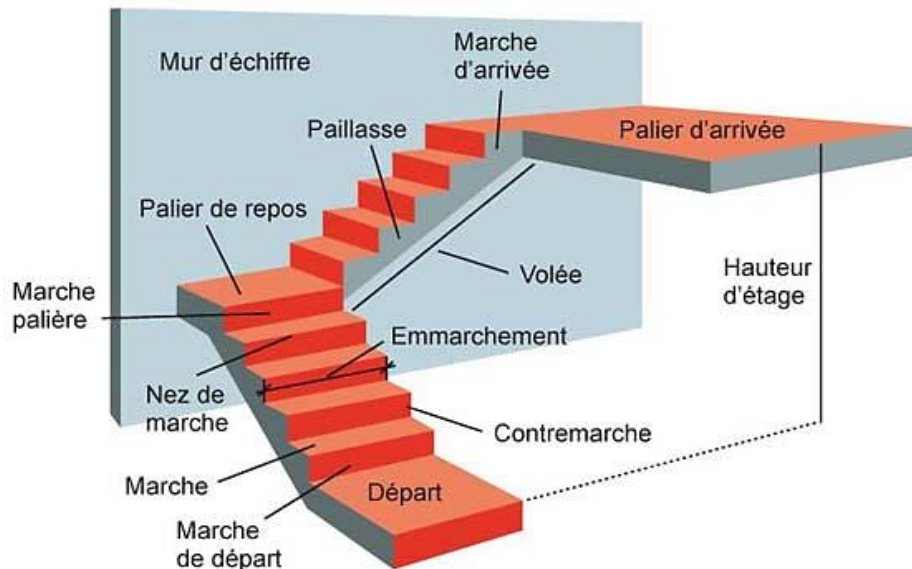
Escalier à paillasse porteuse (source : <https://forums.autodesk.com>).
